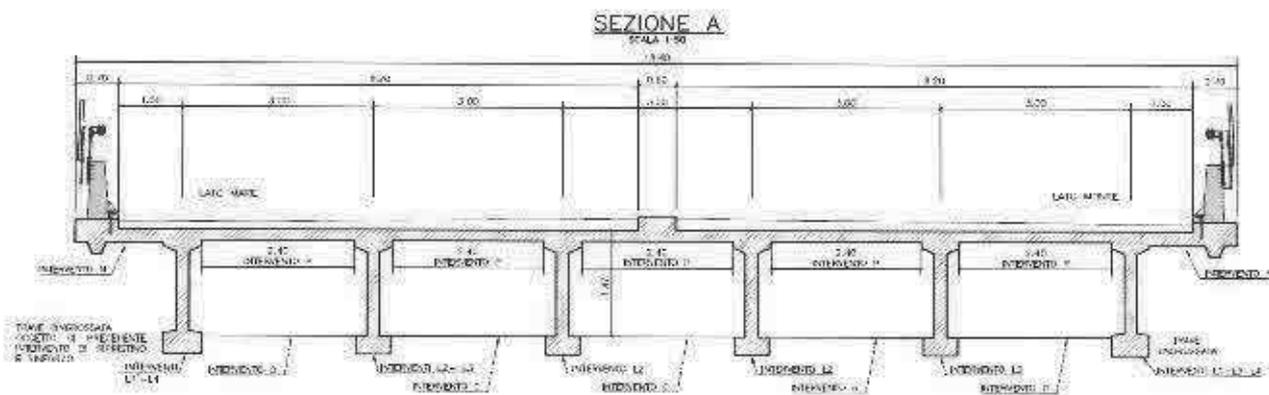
sezione trasversale dell'impalcato tampone appoggiato alle pile
